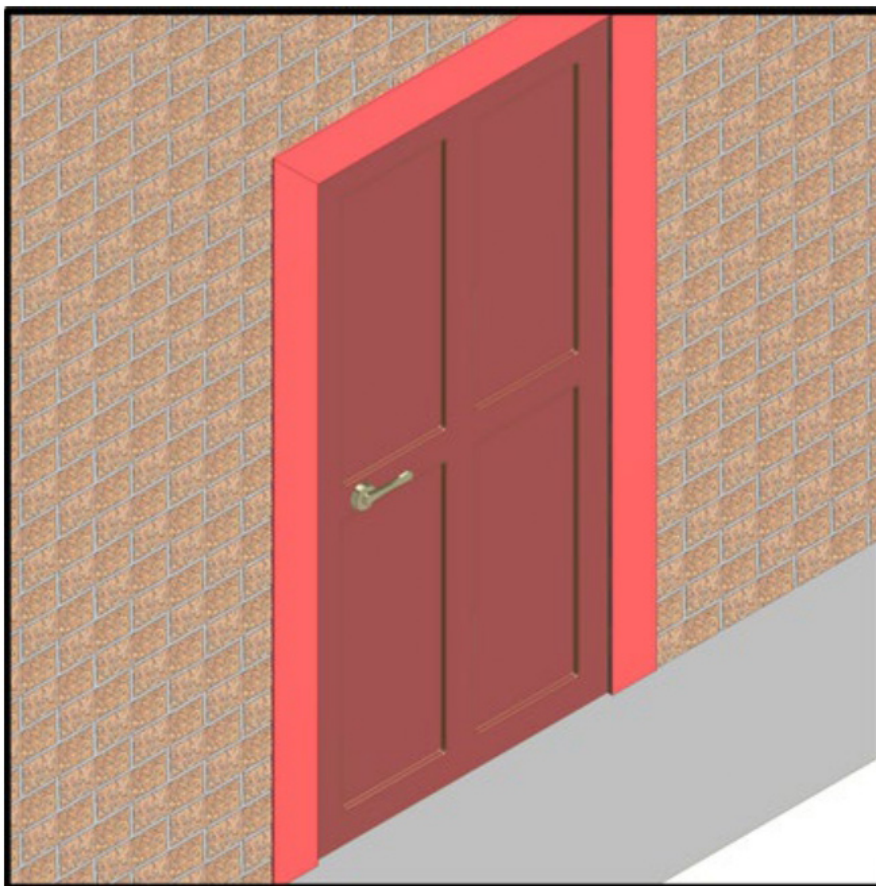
Монтаж фасадной плитки вокруг дверного проёма.
